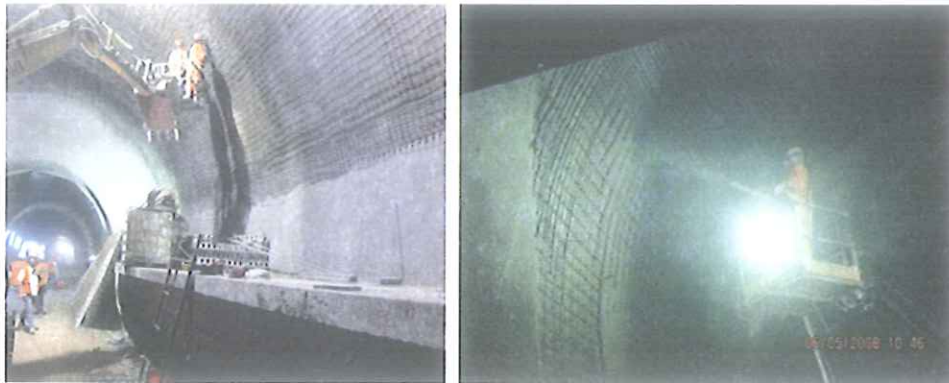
Revestimiento: Colocación de mallas de acero (izq.) y hormigón proyectado (der.)
